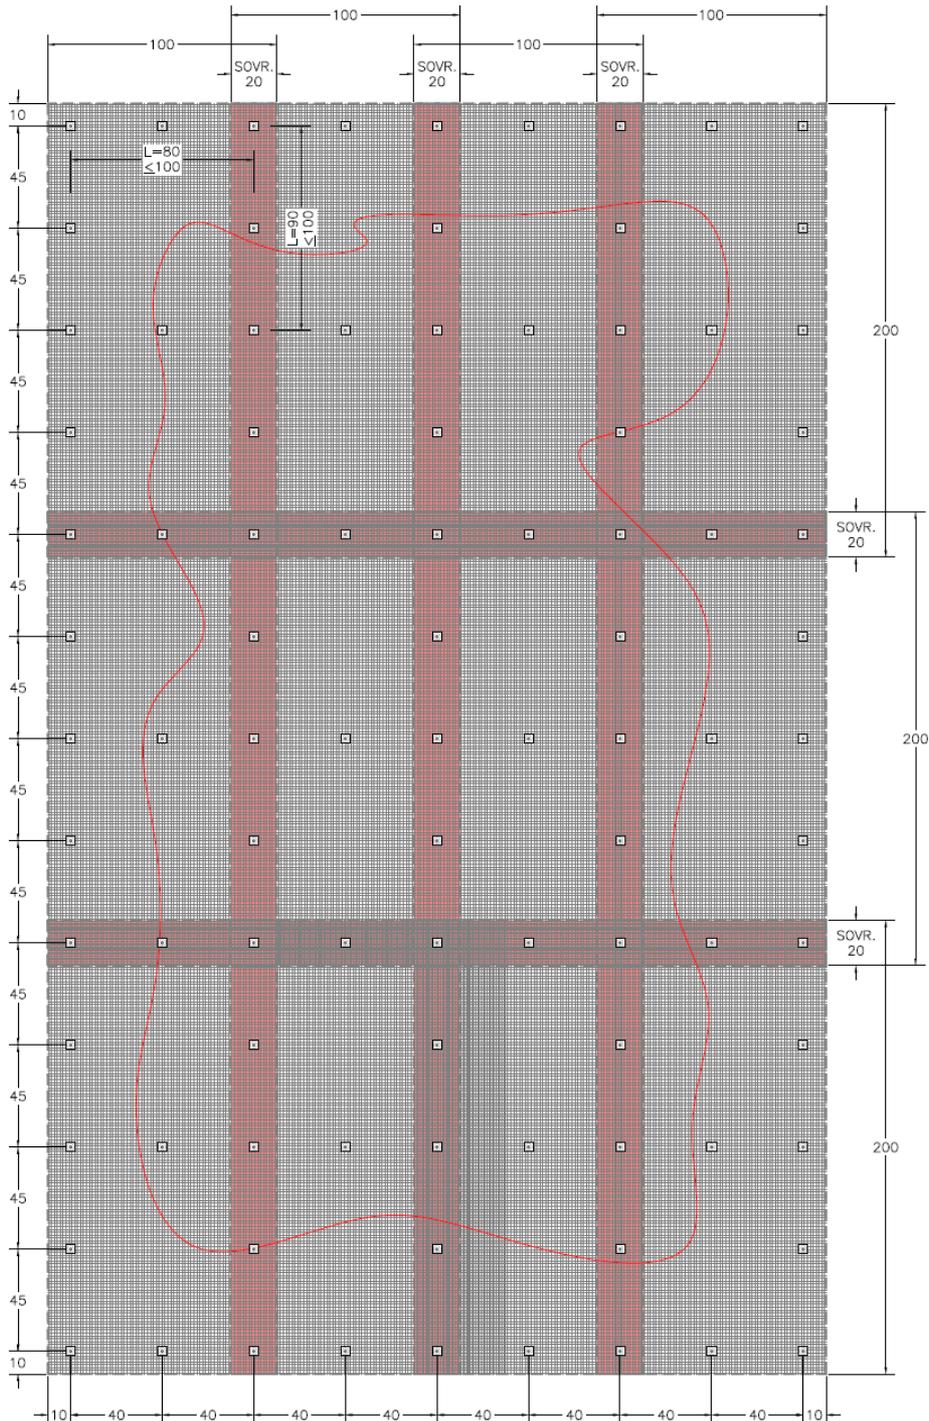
Schema disposizione tasselli pannelli 1x2 m
